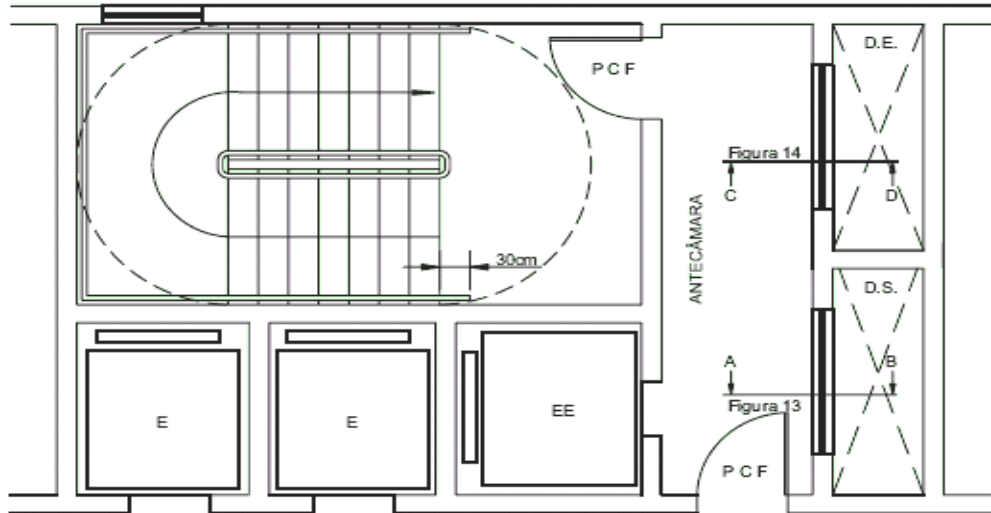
Escada enclausurada à prova de fumaça com elevador de emergência na antecâmara
